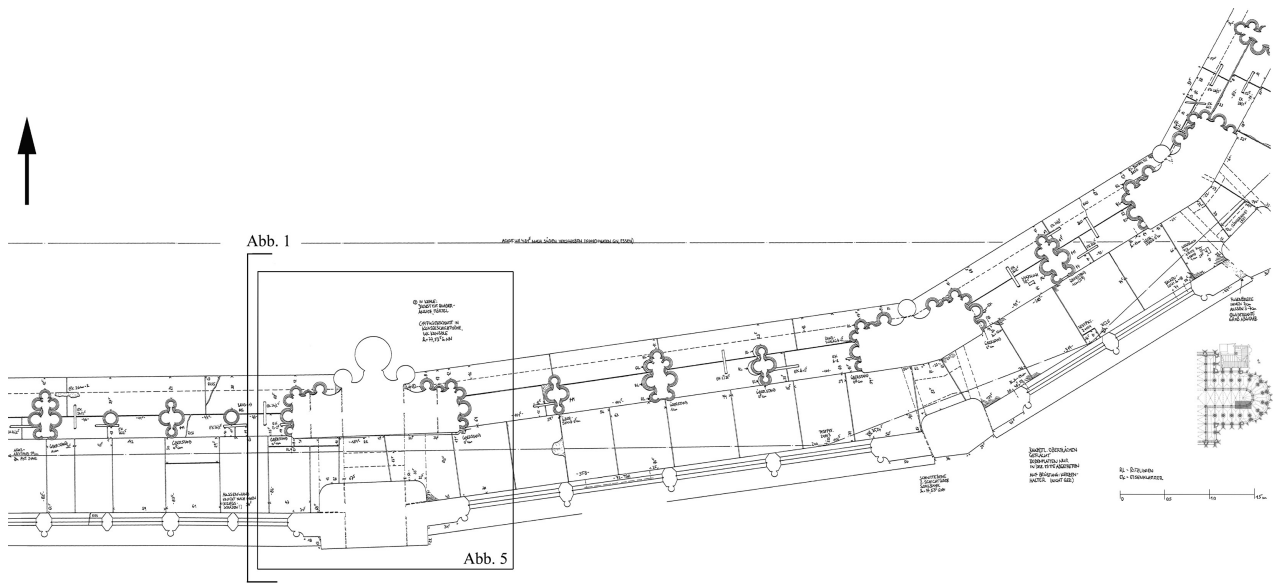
Köln, Dom, Teilgrundriss des Triforiums, Übergang vom südlichen Langchor zum Polygon (Schnittführung Abb. 1 und Ausschnitt Abb. 5)
